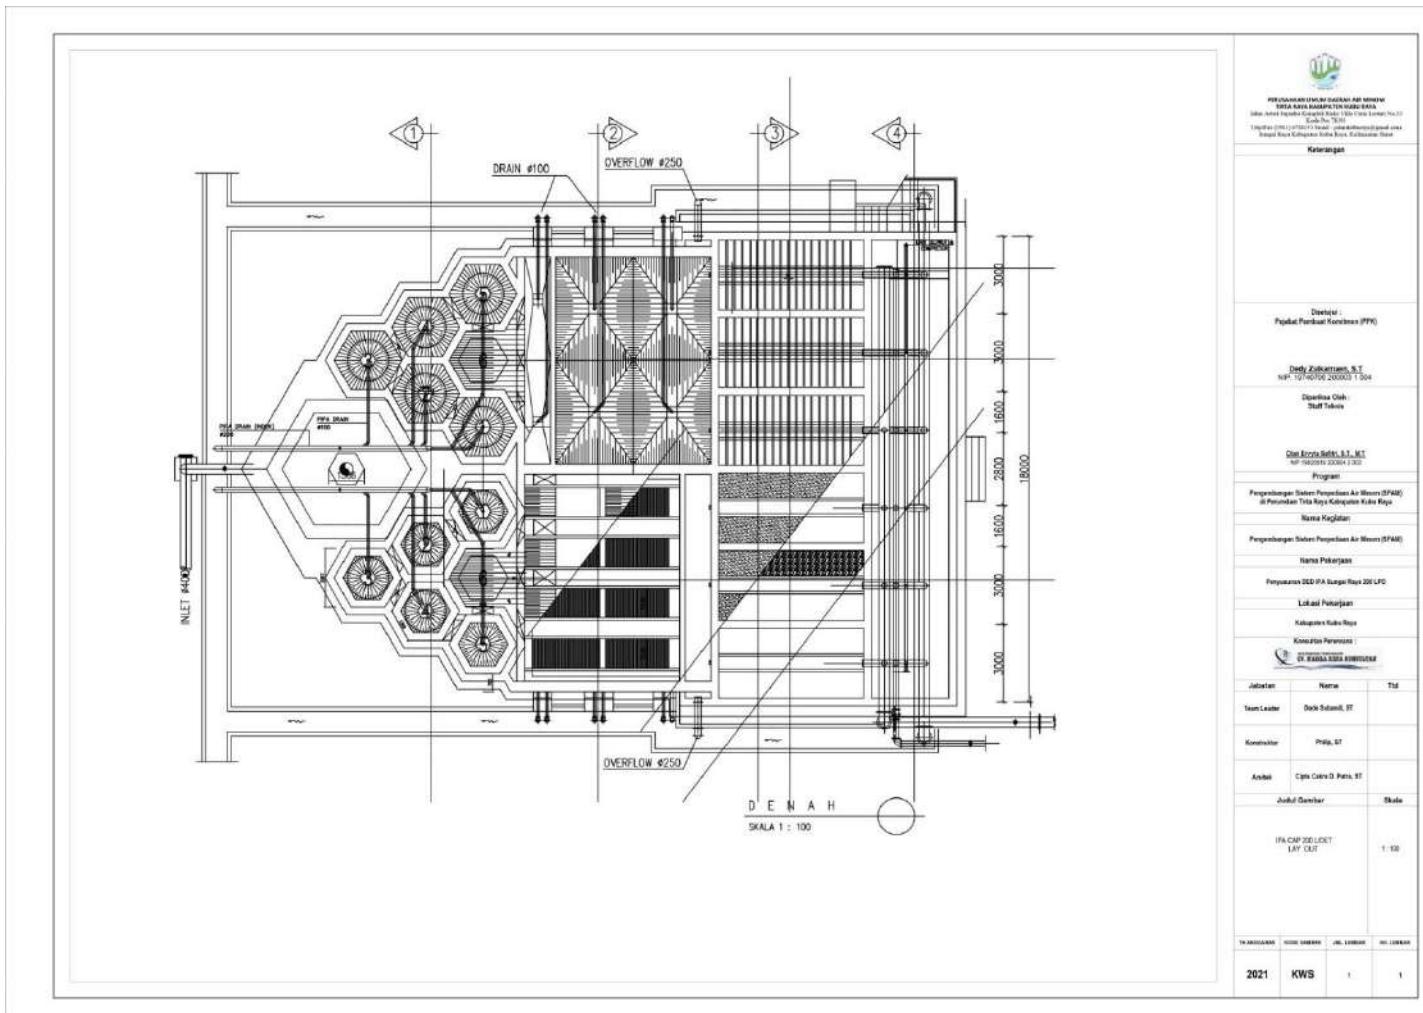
8 Site Plan Pembangunan IPA Sungai Raya 200 LPD
